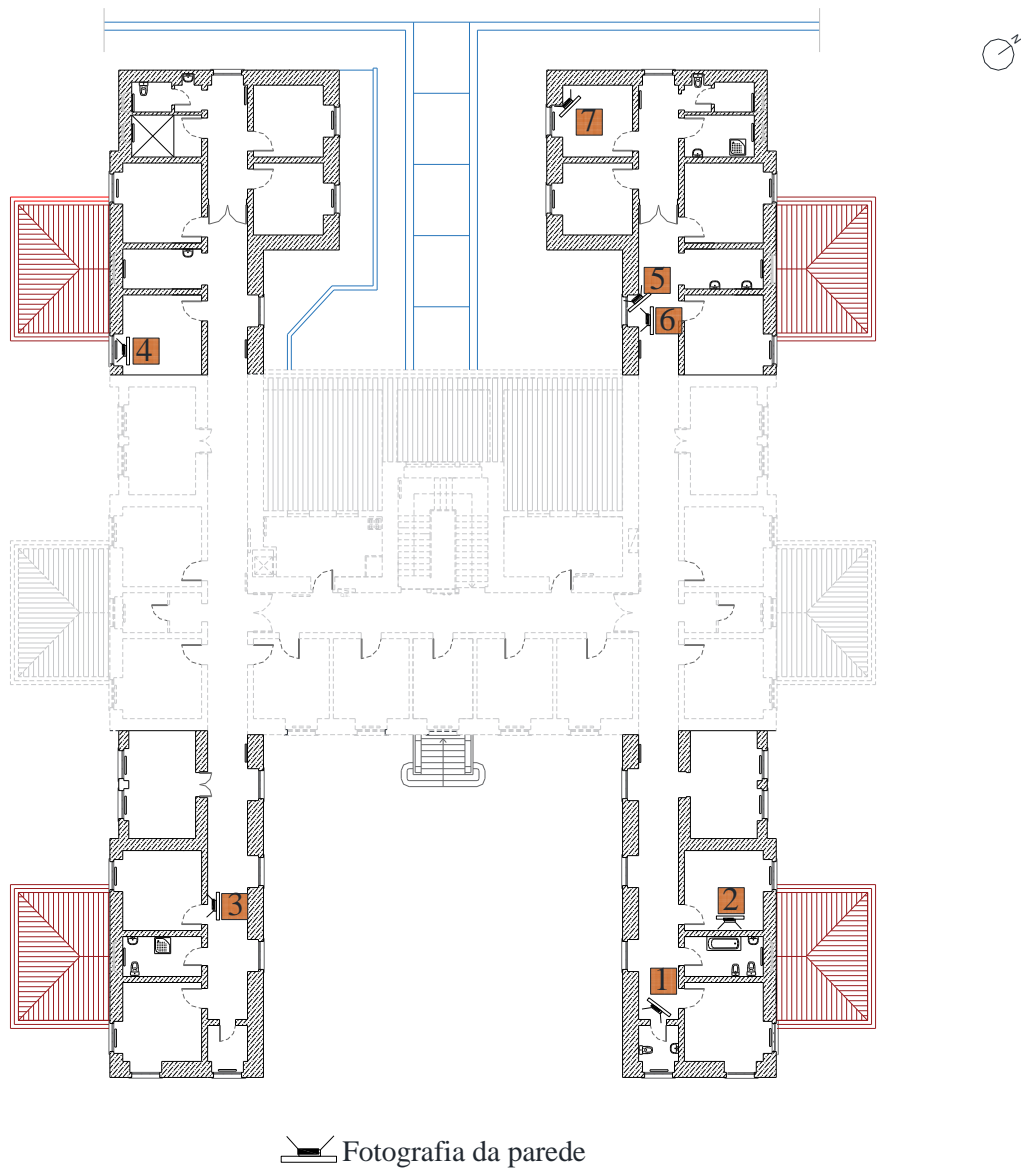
Localização das Imagens , na planta do Piso 1 [Fonte: Planta cedida pelo C.H.J.M]
